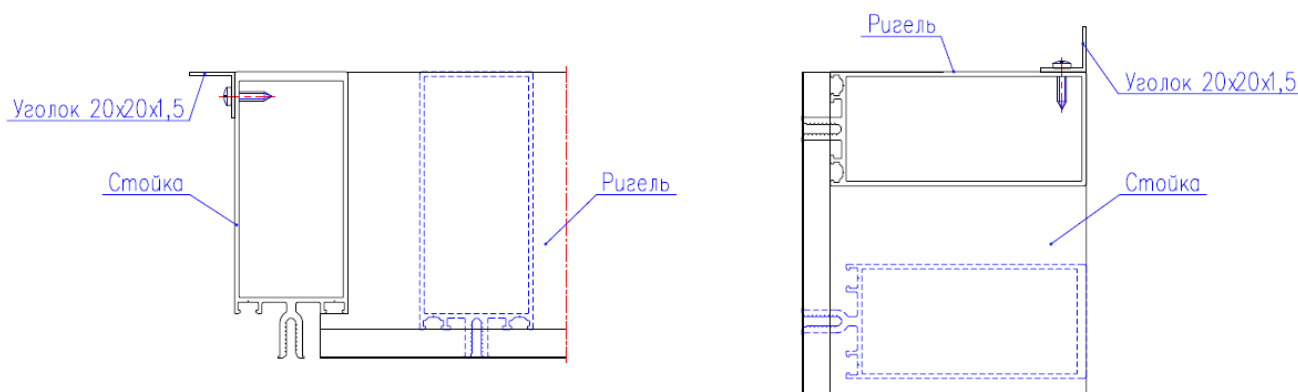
Примыкание конструкции к перекрытию (стене здания).
